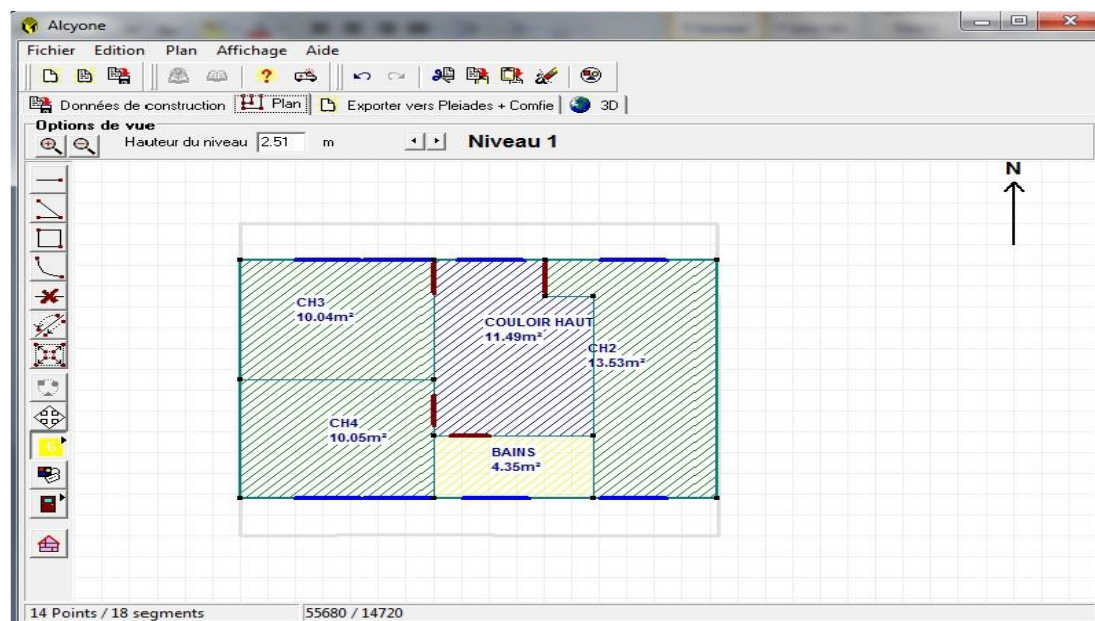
Plan 2^{em} ETAGE dessiné avec ALCYONE.
